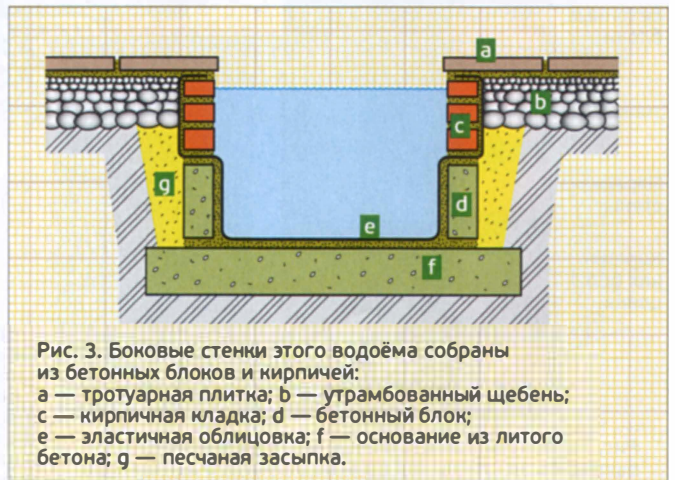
Боковые стенки этого водоёма собраны из бетонных блоков и кирпичей: а — тротуарная плитка; б — утрамбованный щебень; с — кирпичная кладка; д — бетонный блок; е — эластичная облицовка; ф — основание из литого бетона; г — песчаная засыпка.
